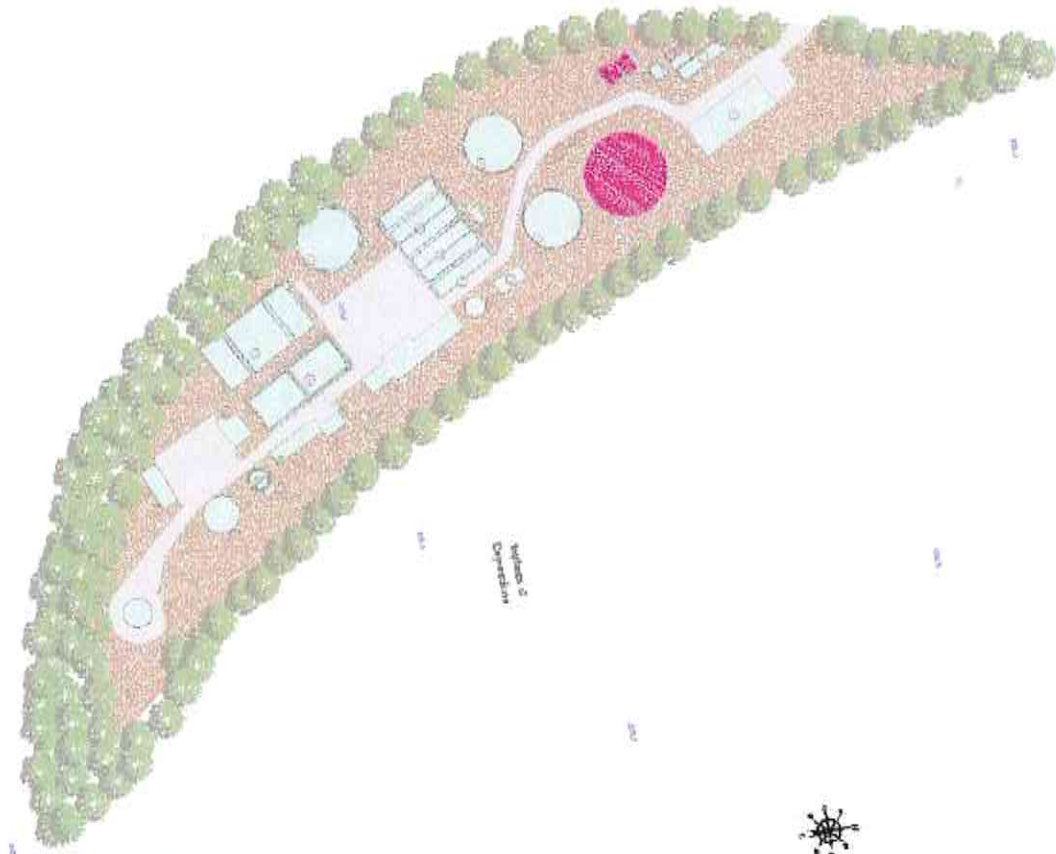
Stato di progetto dell'impianto (in rosa le strutture da realizzare).
